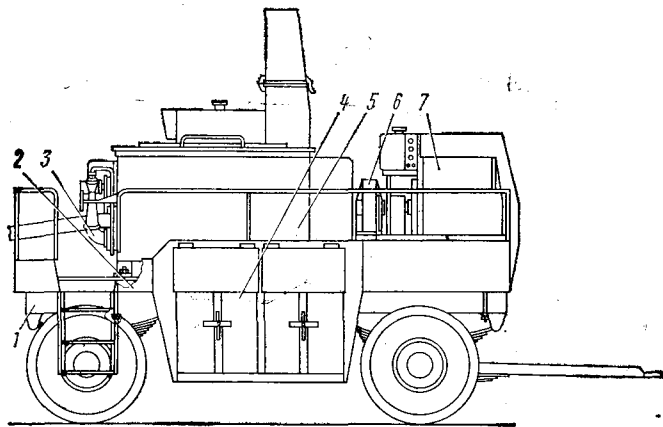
Оборудование для разогрева термопластика: 1 — тракторный прицеп 2ПТС-4; 2 — рама; 3 — инжекционные горелки; 4 — баллоны для сжиженного газа; 5 — котлы; 6 — редуктор; 7 — двигатель Д-21А
